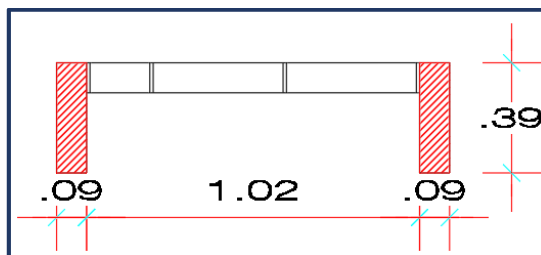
Esquema del Tipo 2 – Vista Planta.
